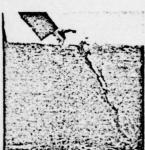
表のり工小段のクラック -Photo 5.58 - Small Step Crack of Face Spread
